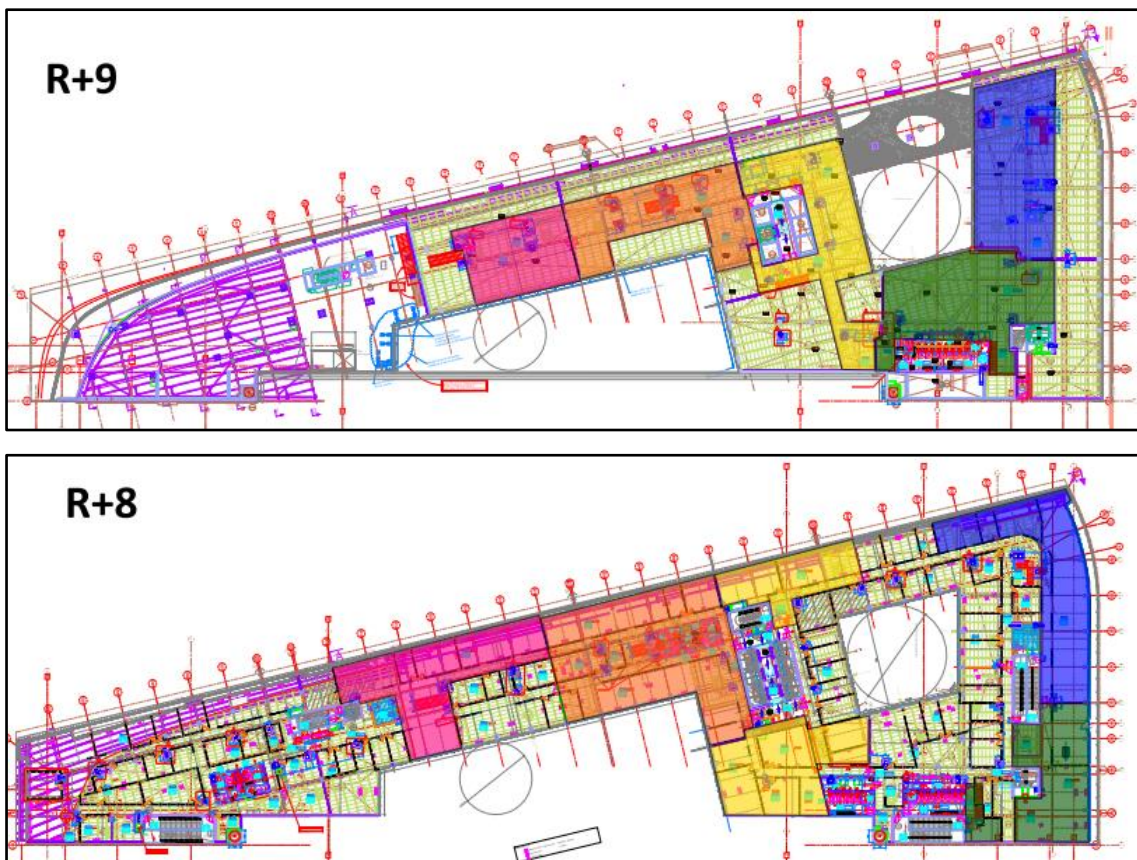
Plan du N8 et N9 avec zones à éviter en superposition de travaux et journées d'OPR
